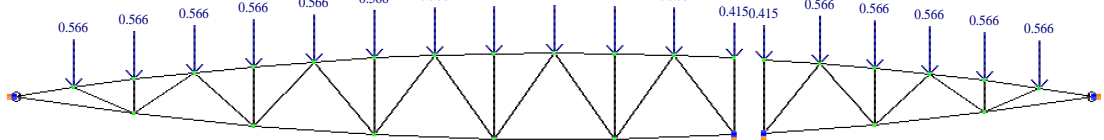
Загрузка №3. Вес конструкции кровли
